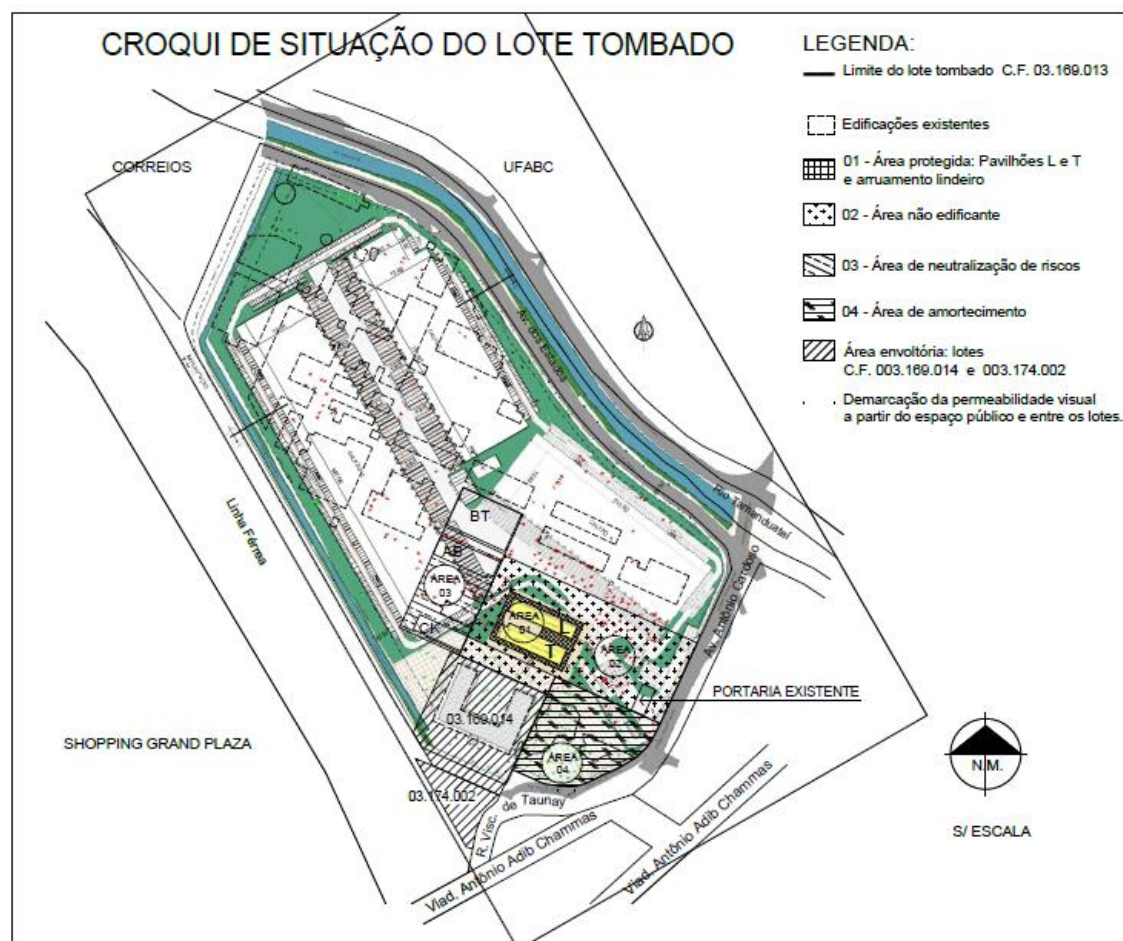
Sobreposição do croqui de situação do lote tombado com o plano de ocupação
